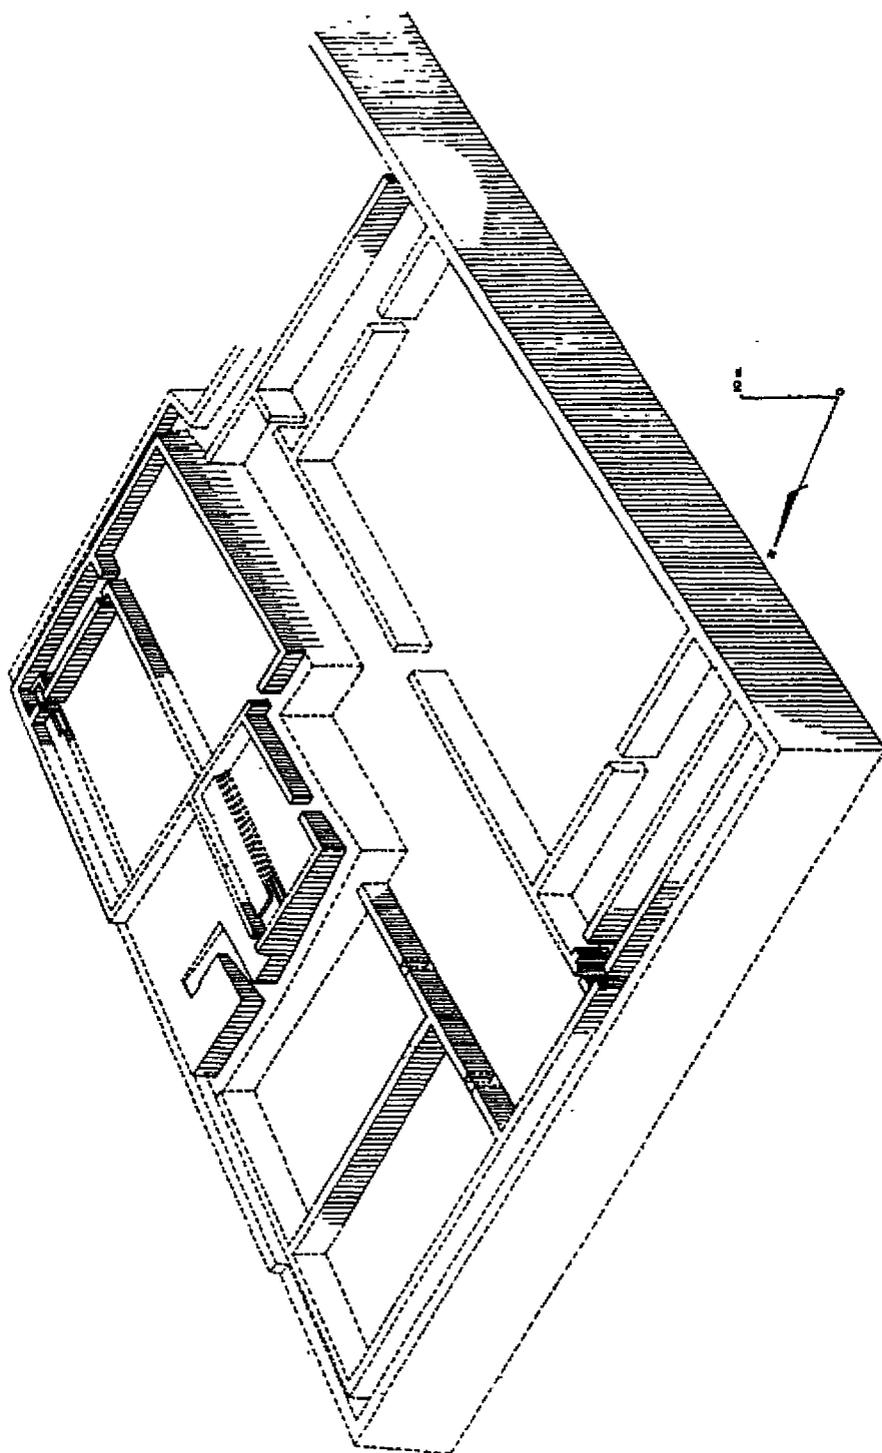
Reconstrucción hipotética de la Etapa 3 constructiva de la Plataforma I.
